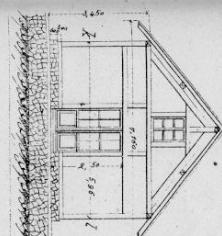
Plan. Coupe k.l à 0,005 p<sup>2</sup>/m.
